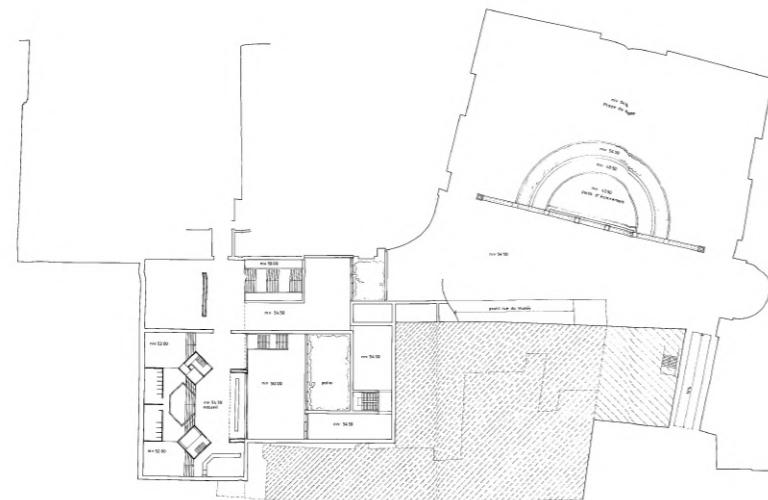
Plan du niveau d'accueil, 1^{ère} esquisse du musée camouflé.
